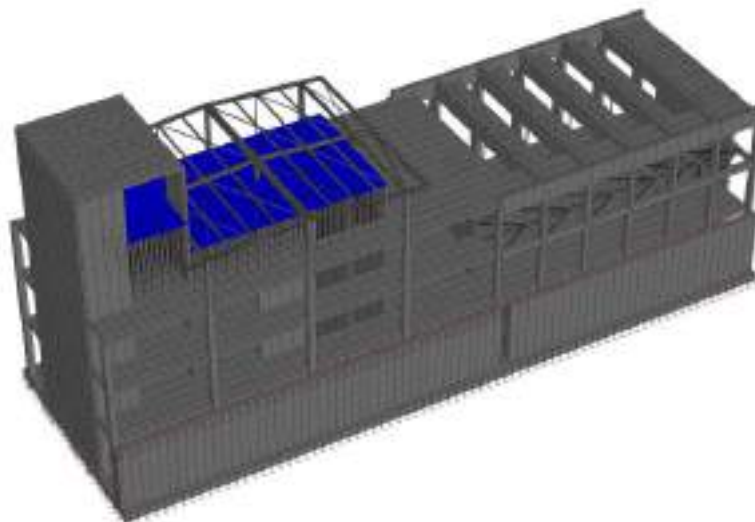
implementazione del carico pacchetto pavimentazione L3 – $g_k = 3.60 \text{ kPa}$.
